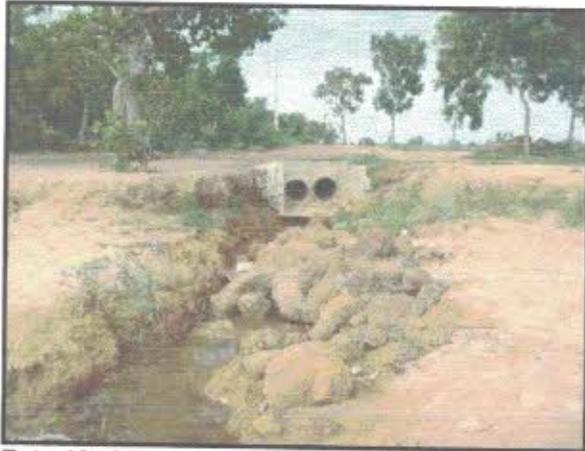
Vista do lançamento do sistema de drenagem pluvial nas margens do Lago do Lajeado.
